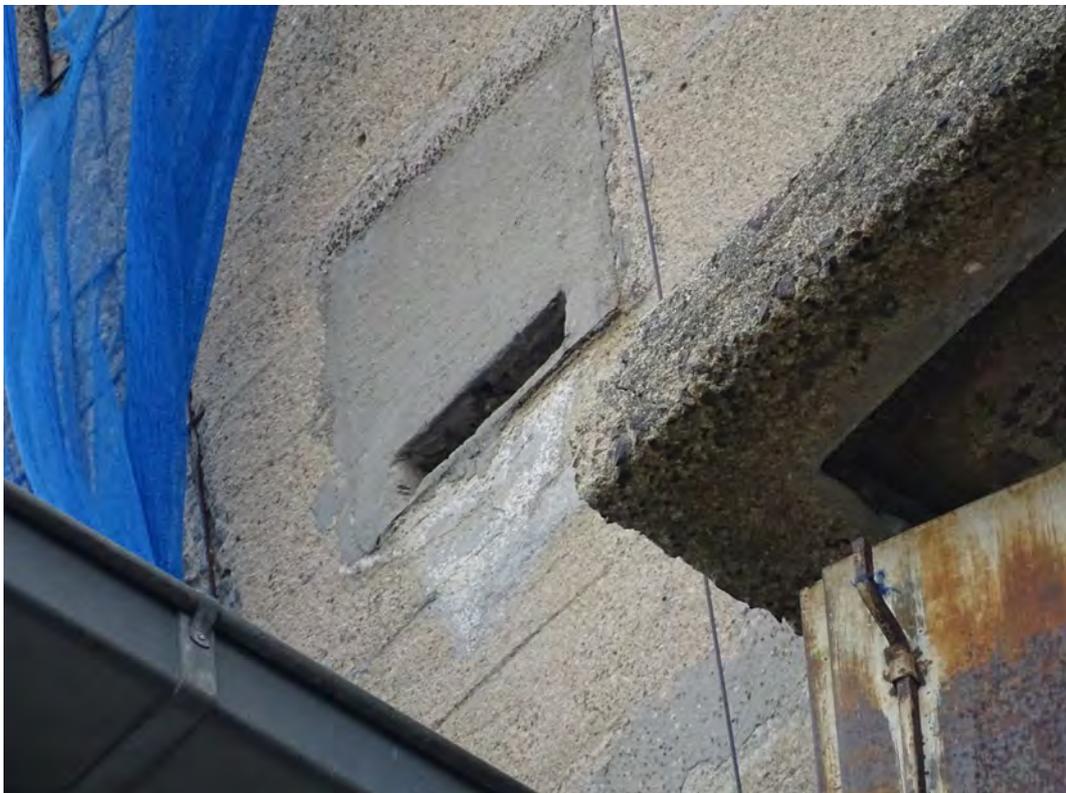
in die Fassade vom Gebäude Zwickauer Straße 225 eingebautes Fledermausquartier
